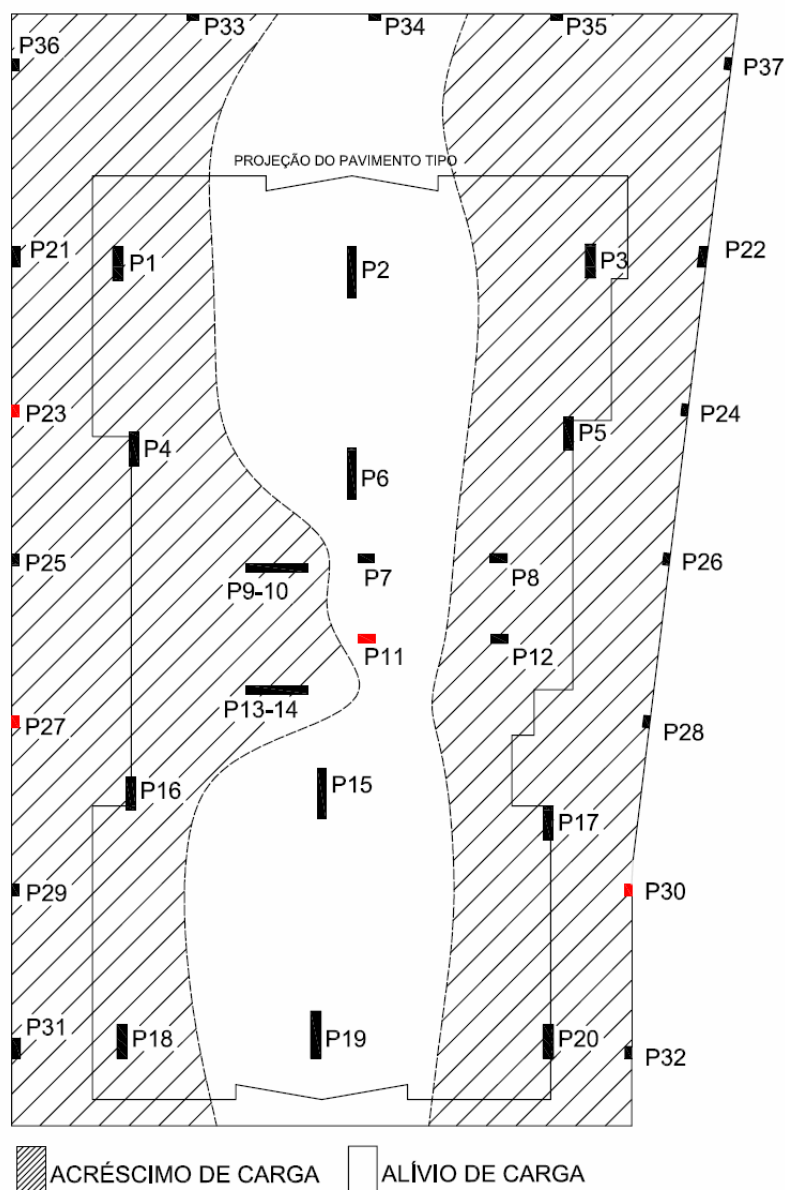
Planta de localização dos pilares no pavimento térreo com sinalização de alívio ou acréscimo de carga nos apoios devido aos recalques.
